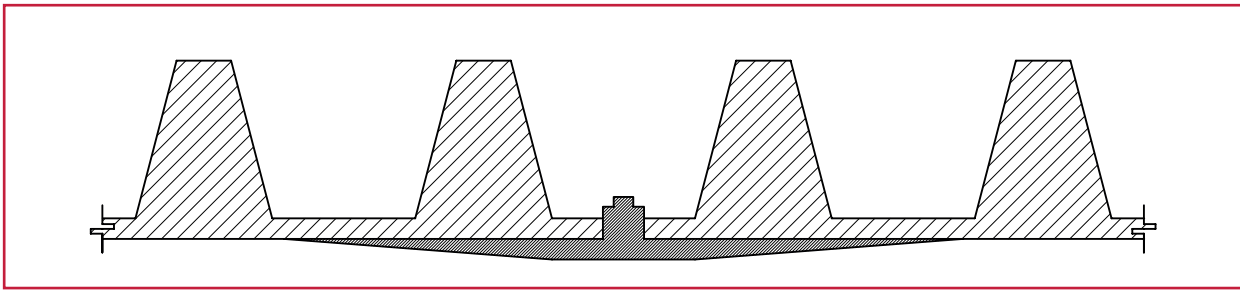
Tubería de pared estructurada corrugada de doble pared
